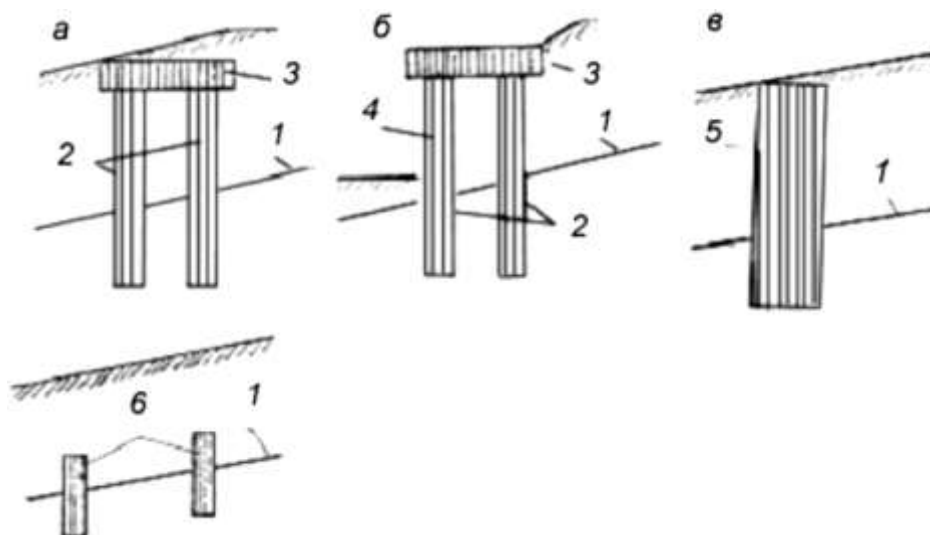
Схема свайных и столбчатых удерживающих конструкций: *а, б* – свайные конструкции; *в* – железобетонные столбы; *г* – свай-шпонки; *1* – предполагаемая поверхность сдвига; *2* – железобетонные сваи; *3* – монолитный железобетонный ростверк; *4* – облицовочная железобетонная плита; *5* – железобетонный столб; *б* – свая-шпонка
